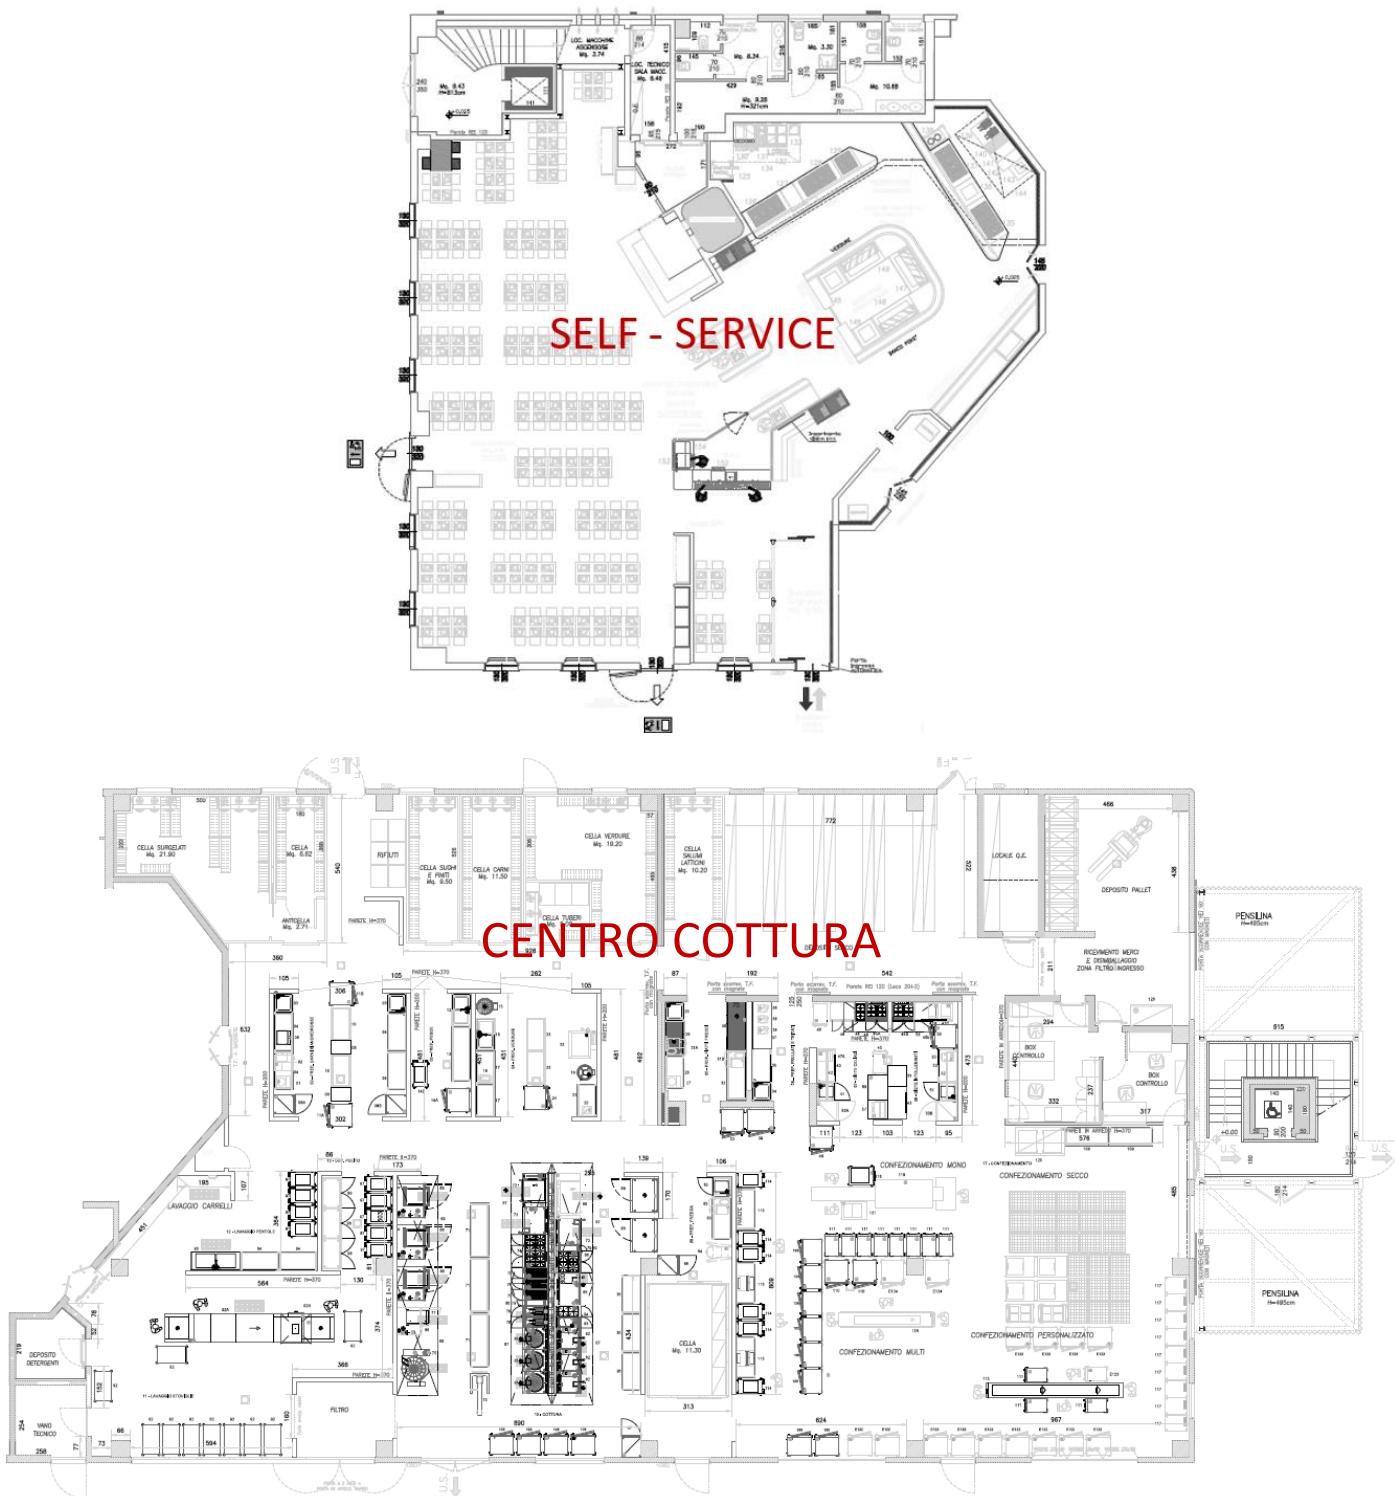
Sito di via della Punta 21-23 - Planimetria piano terra: centro cottura e self-service
